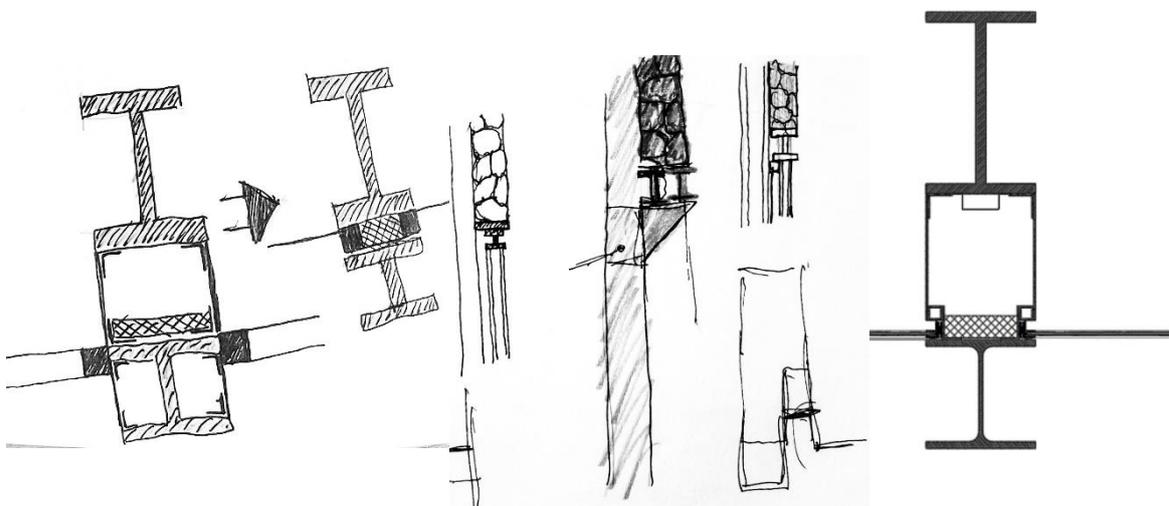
Conexões entre a estrutura existente e a atual na área da restauração
